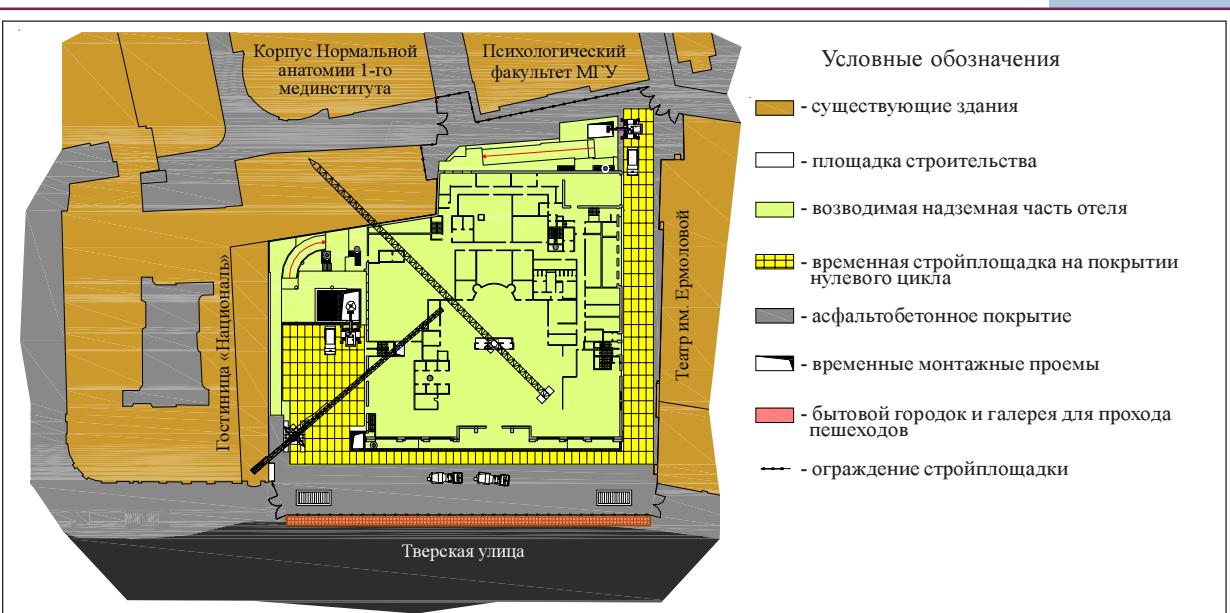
Временная строительная площадка на перекрытии. Начало экскавации грунта под защитой перекрытий.
